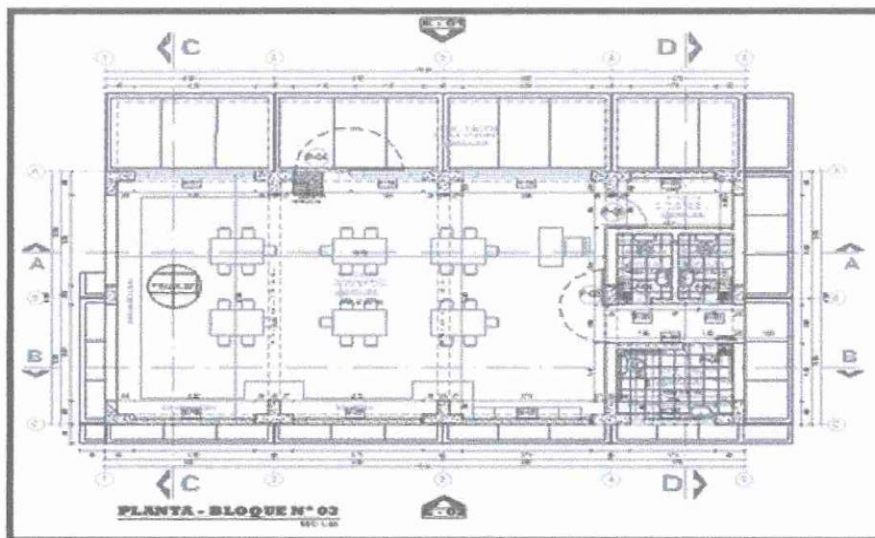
PLANTEAMIENTO BLOQUE N° 03
